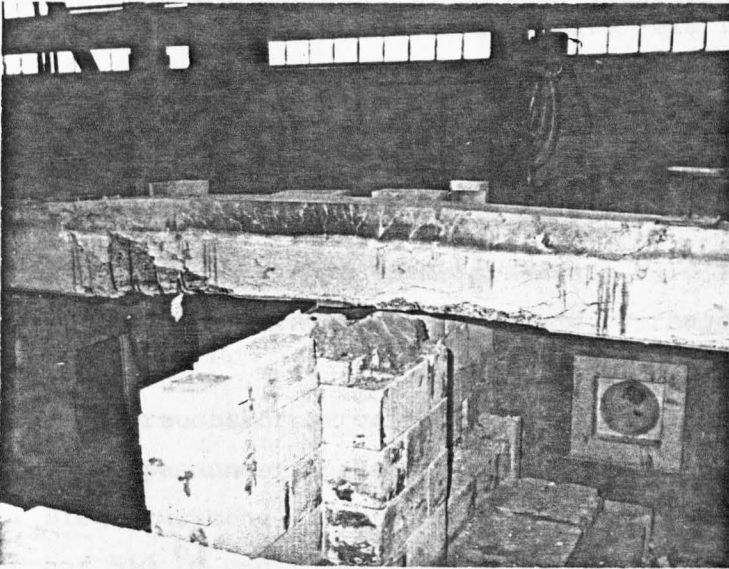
Balken 20 nach dem Wiedererkalten. Die Betonschale außerhalb der Bügel fiel während des Bruchvorgangs herunter
